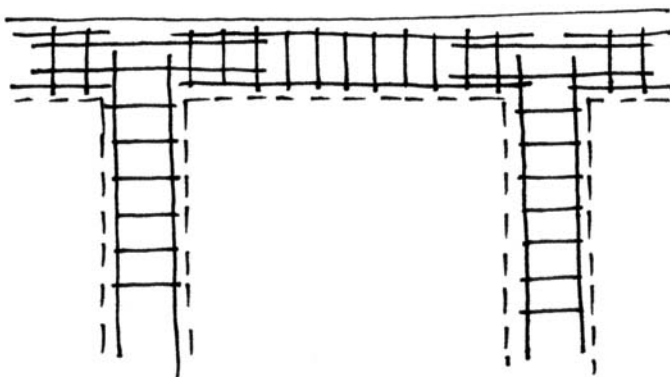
Continuité mécanique entre les fondations et les chaînages verticaux.
